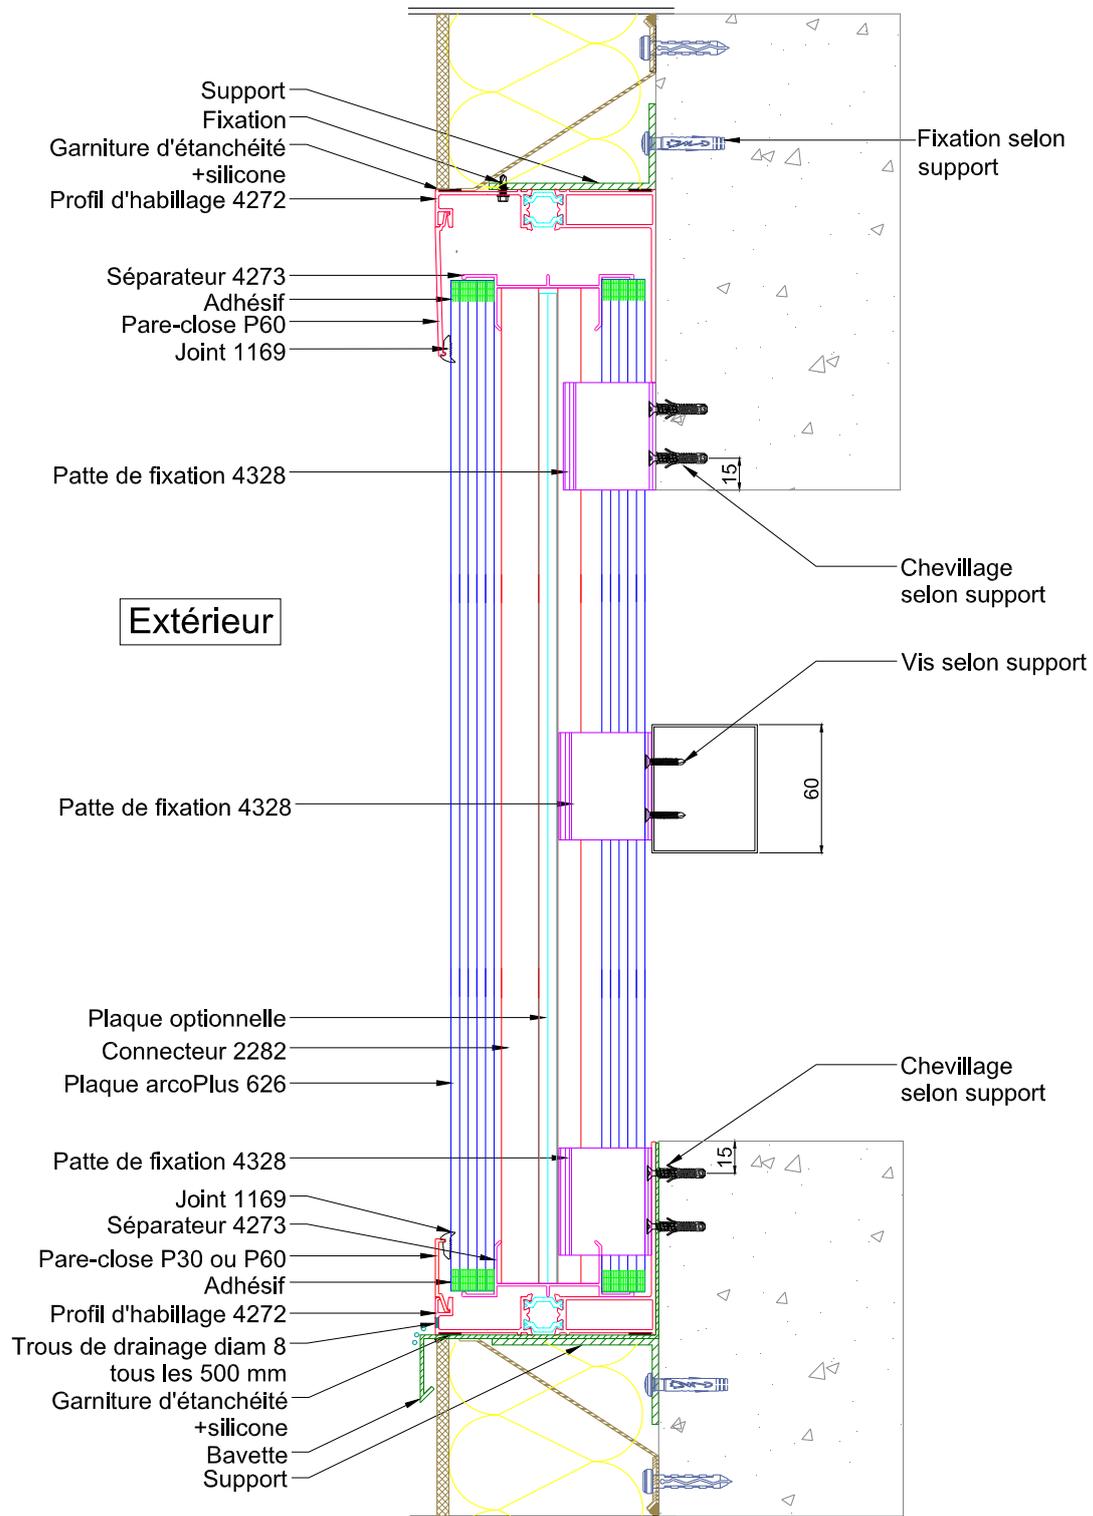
Pose en applique - Hauteurs de façade comprises entre 0 et 6 mètres -
